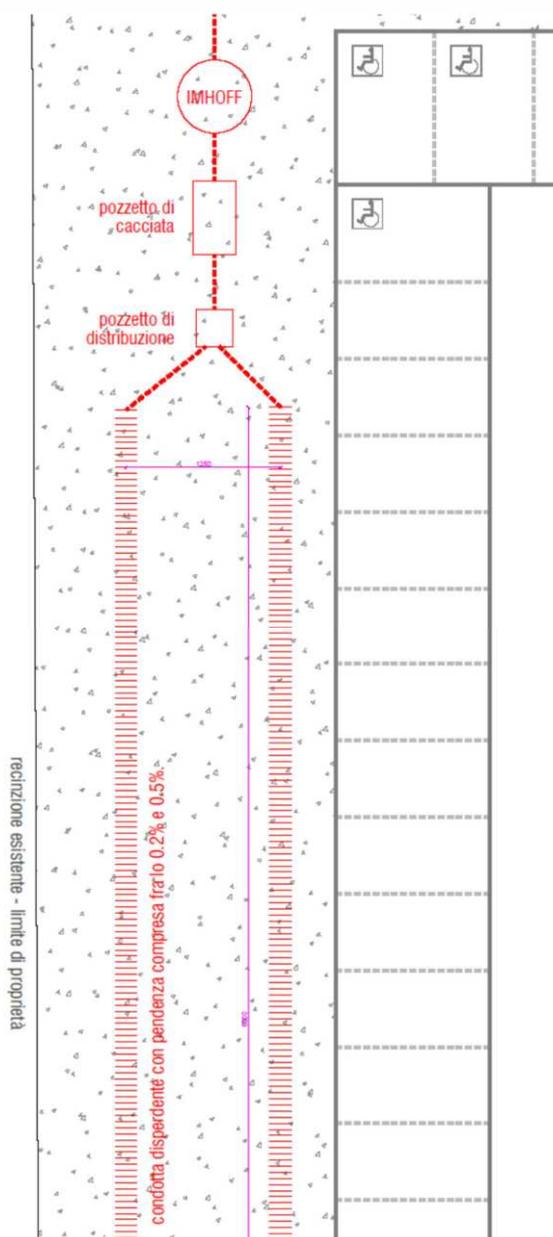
Estratto dalla planimetria di progetto della rete di acque reflue: subdispersione.
